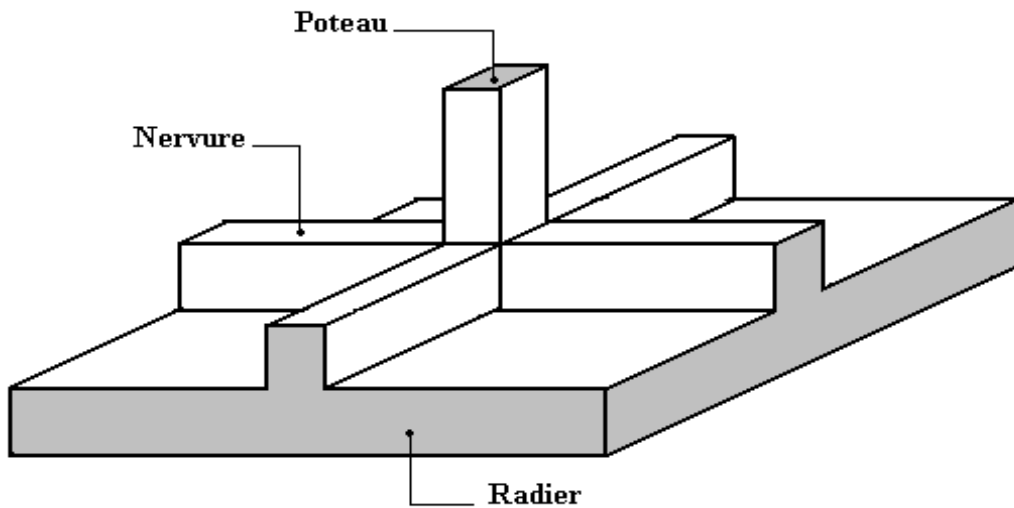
disposition des nervures par rapport au radier et poteau
